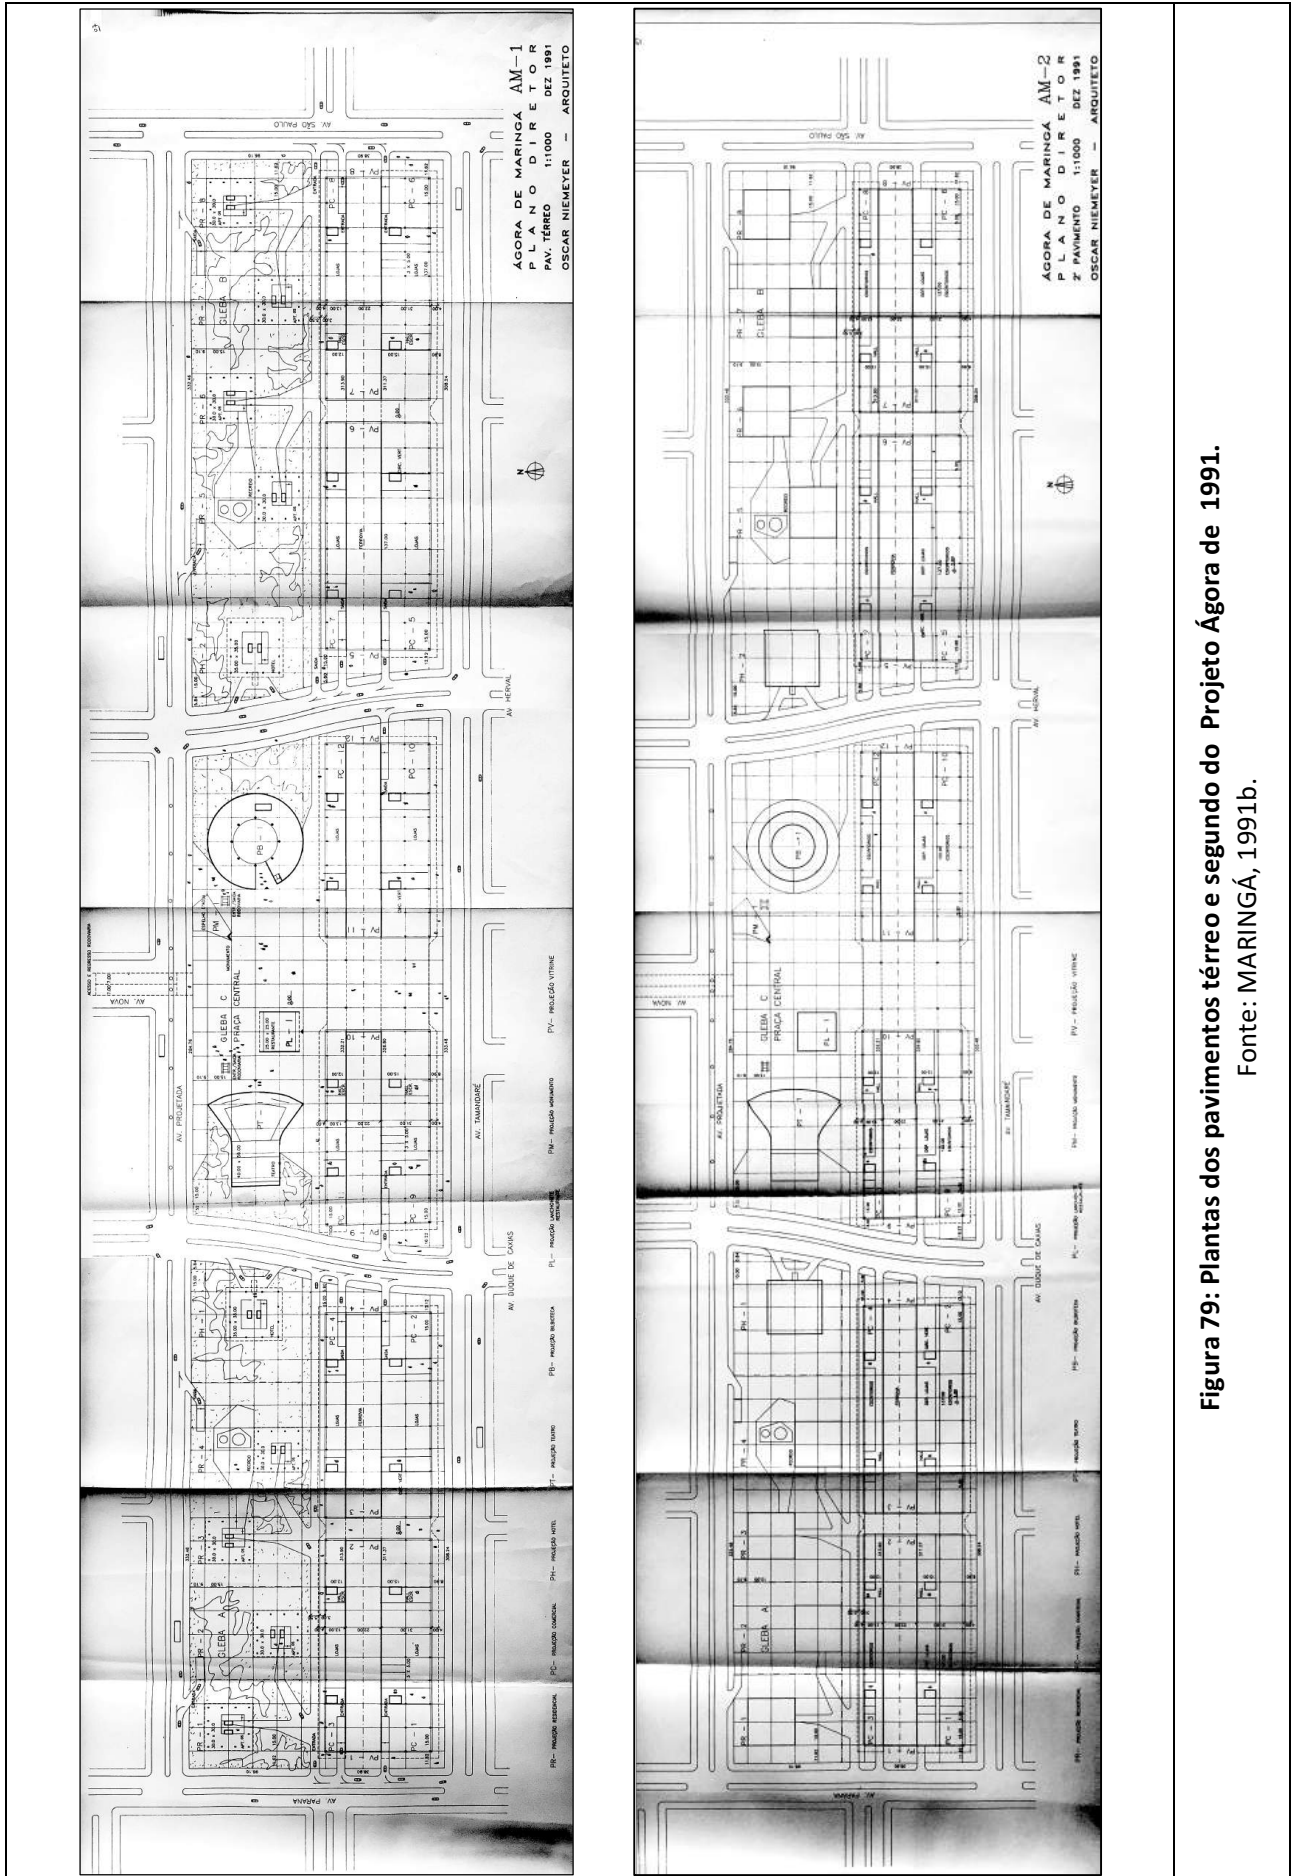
Plantas dos pavimentos térreo e segundo do Projeto Ágora de 1991.
